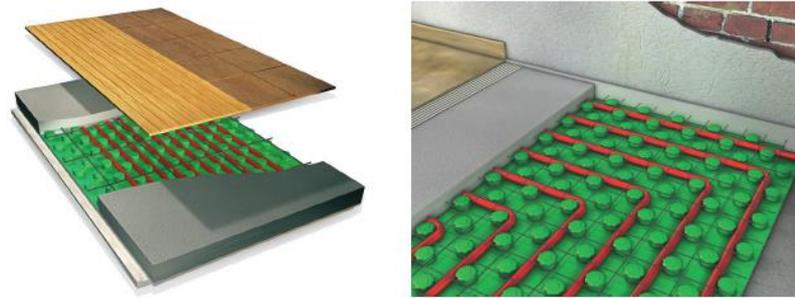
Pavimento radiante ("molhado"), Fabricante: Giacomini
